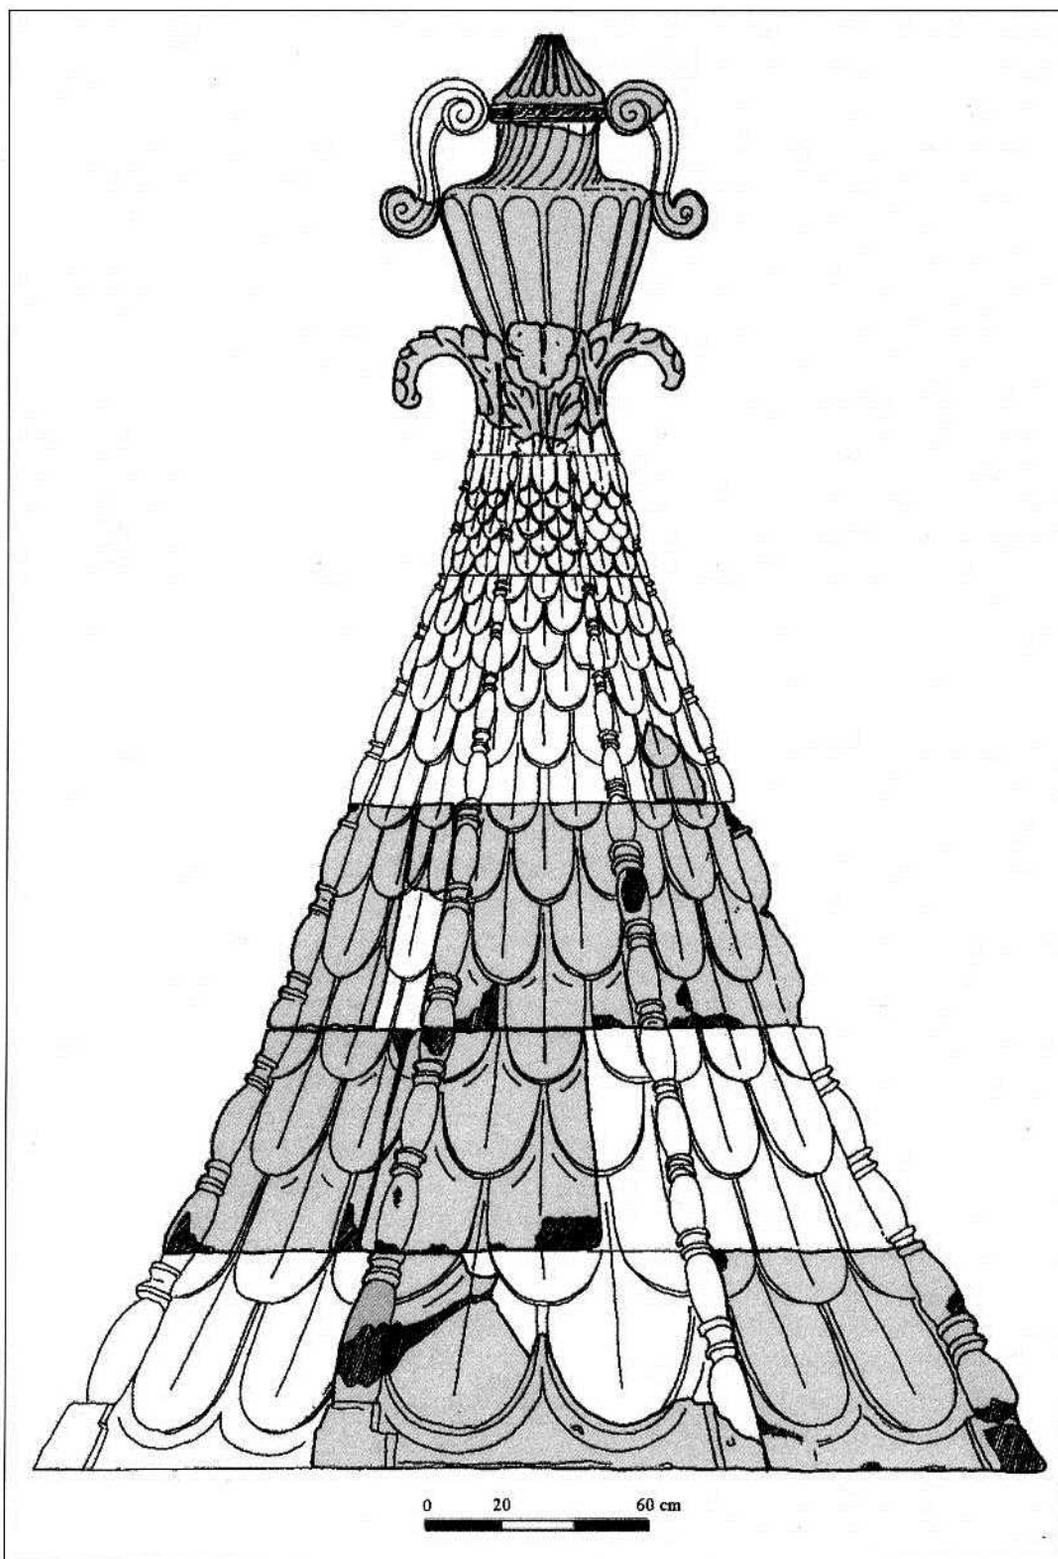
Restitution en élévation de la toiture du mausolée C.
